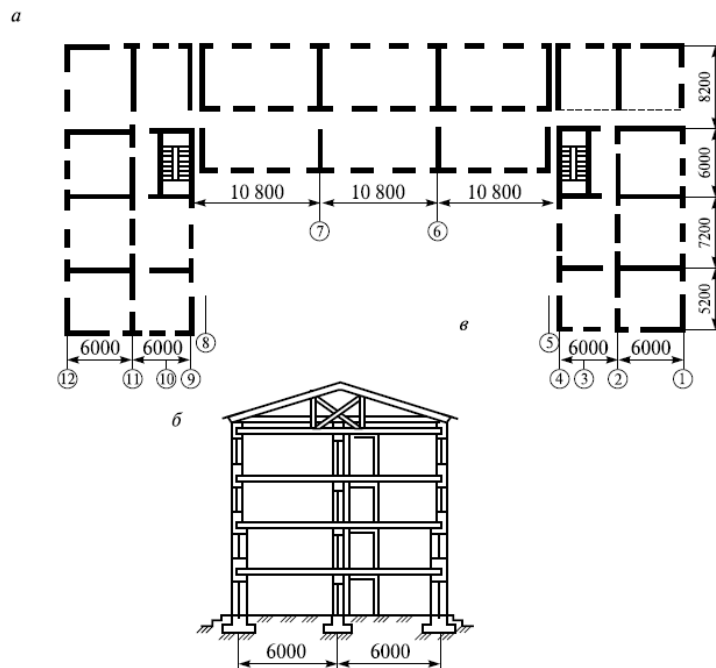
Рассматриваемая расчетная модель здания. А – план типового этажа, б – поперечный разрез, в расчетная схема
